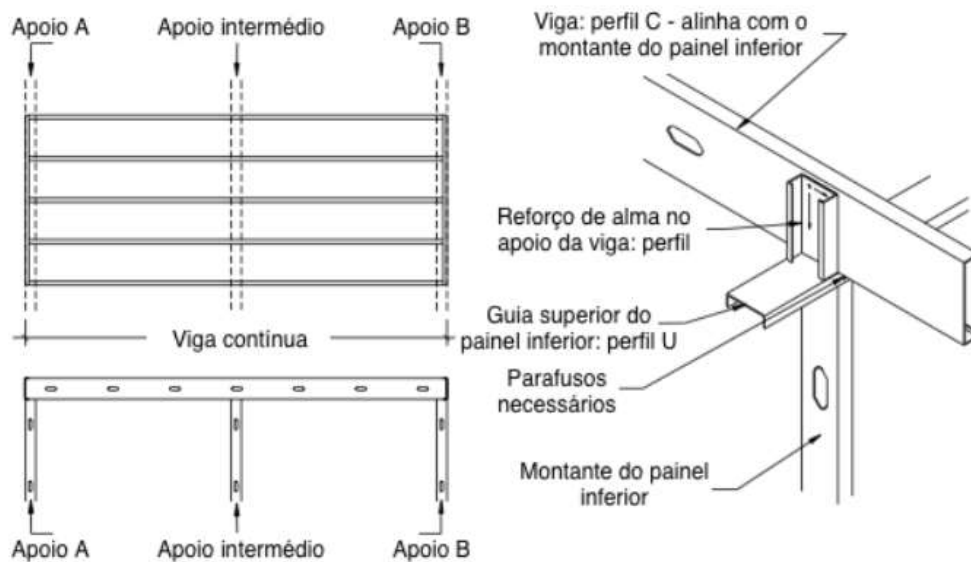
detalhamento de vigas com apoios intermediários [1].
